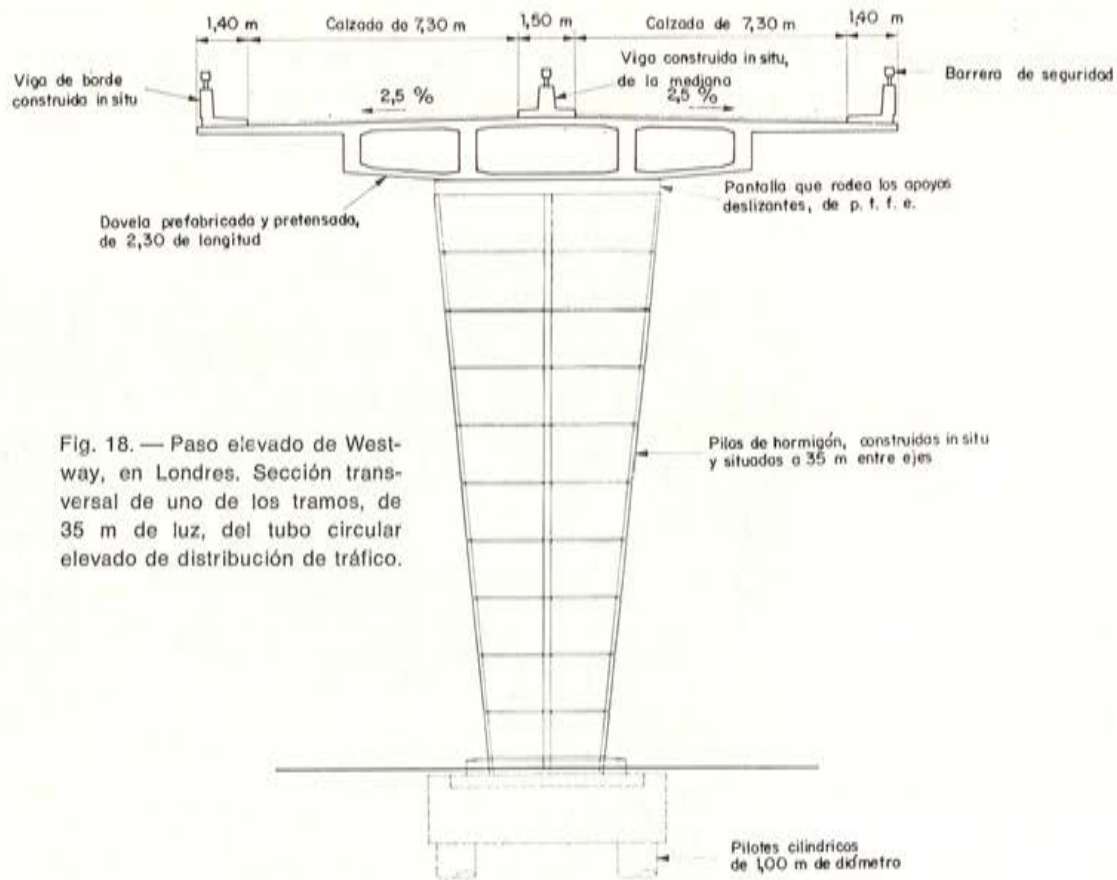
Paso elevado de Westway, en Londres. Sección transversal de uno de los tramos, de 35 m de luz, del tubo circular elevado de distribución de tráfico.
